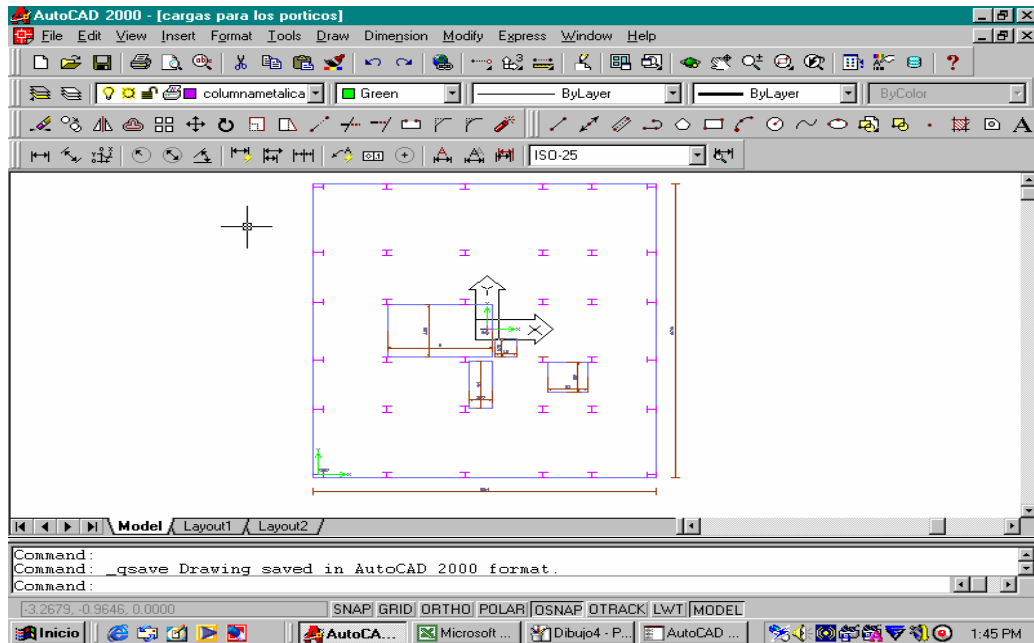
Ubicación del eje de coordenadas en el centro de gravedad de la planta.
